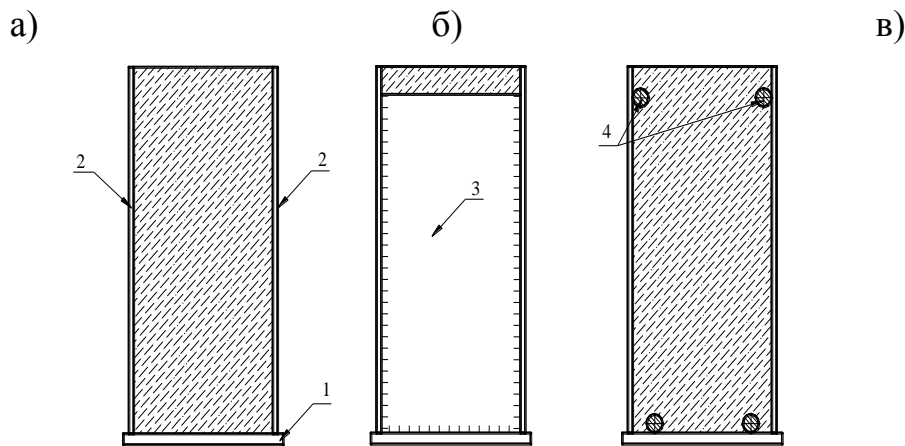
Схеми запропонованих поперечних перерізів сталезалізобетонних балок із зовнішнім листовим армуванням:
